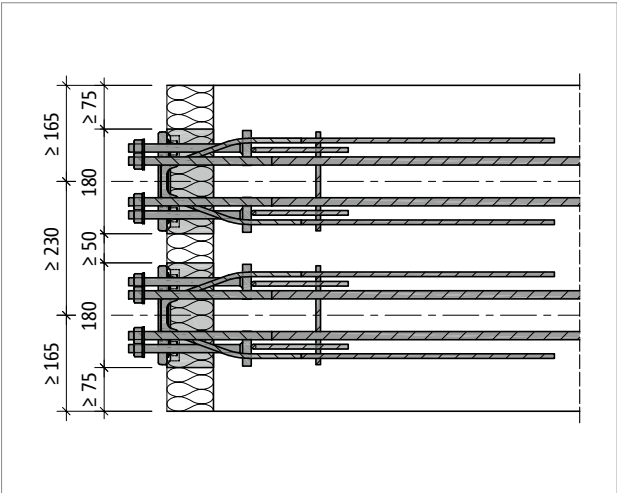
Schöck Isokorb® T Typ SKP: Achsabstand
